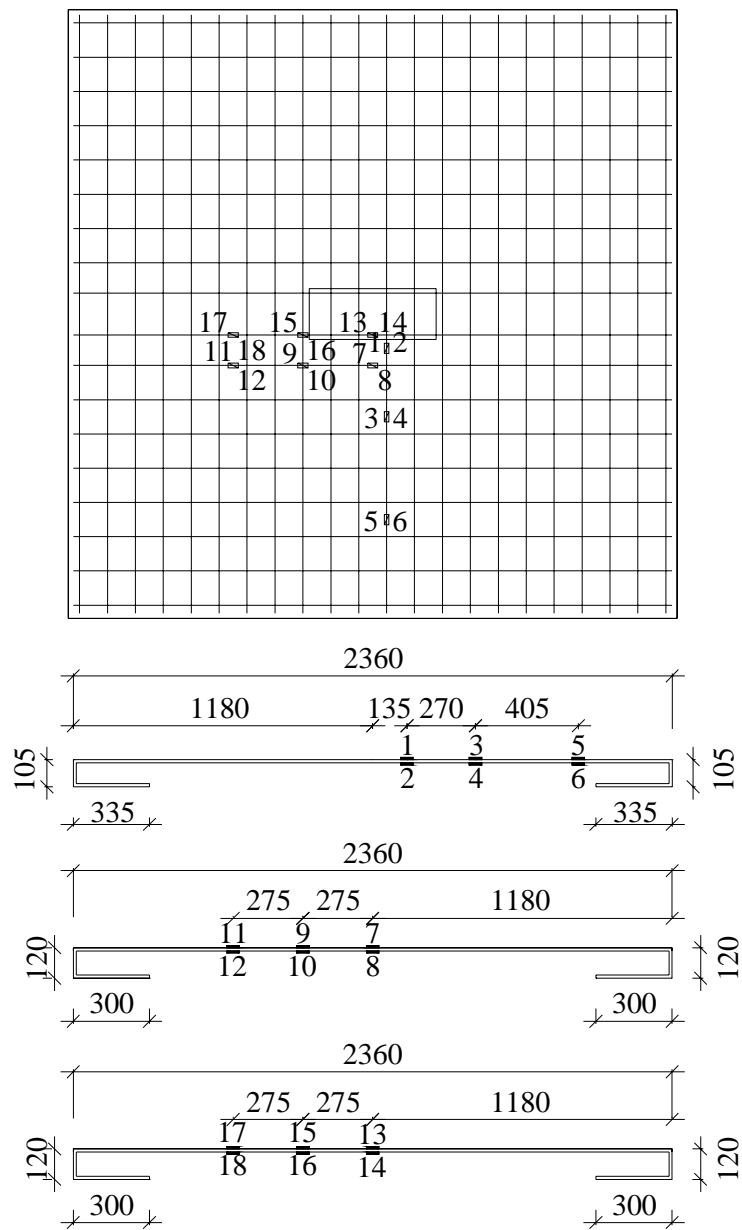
Posicionamento dos extensômetros das lajes L1 (mm)
